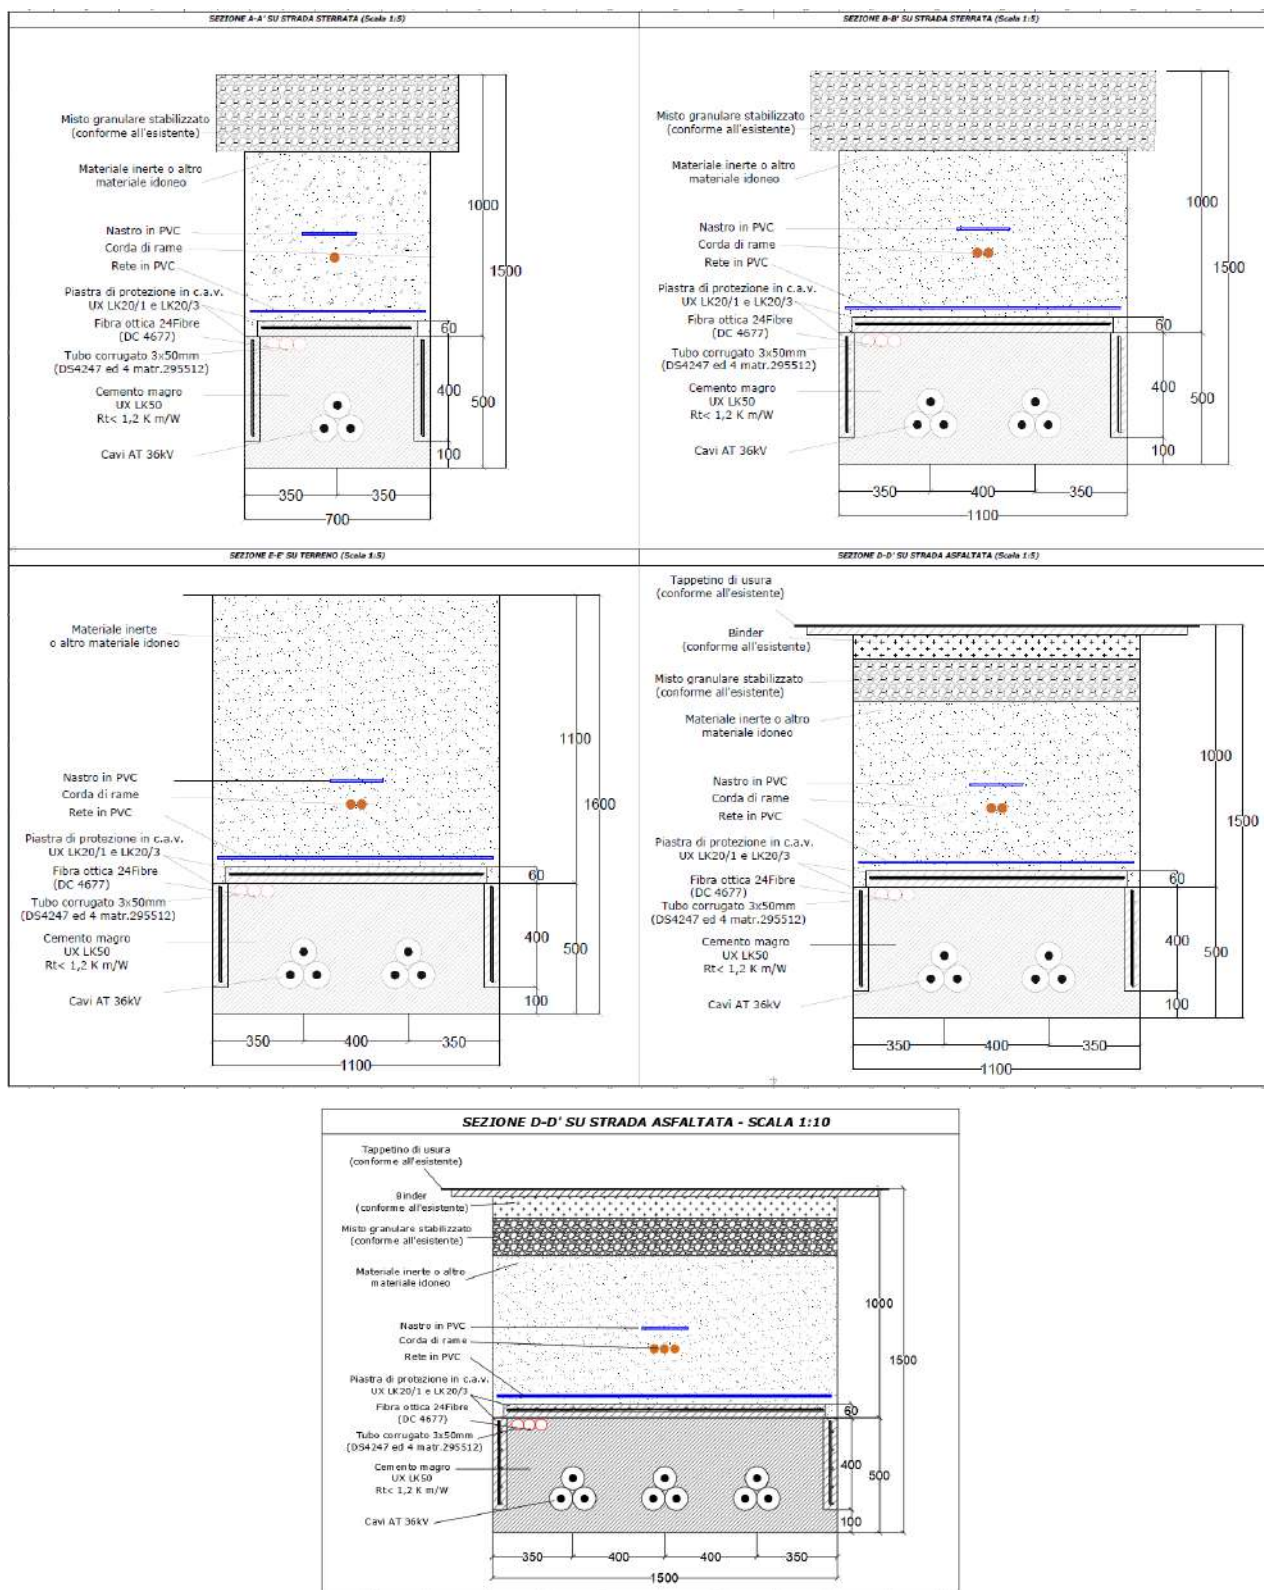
Vista delle sezioni dei cavidotti a 36 kV. Fonte: elaborato di progetto "C21BLN001CWD02600_ Sezioni tipiche cavidotti"
